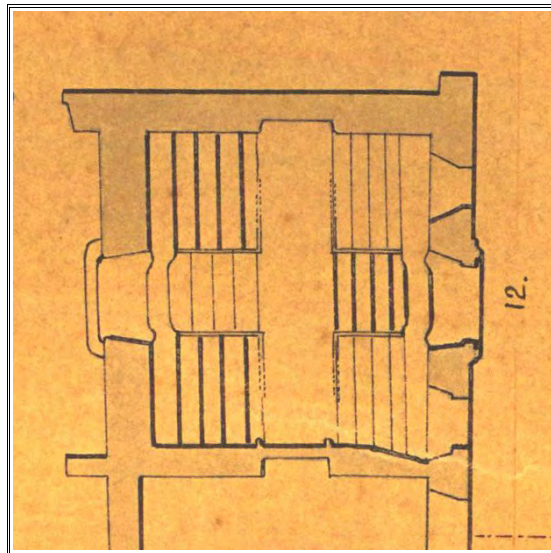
Planta de la escalera, en el plano de 1920, de Félix Caballero.
